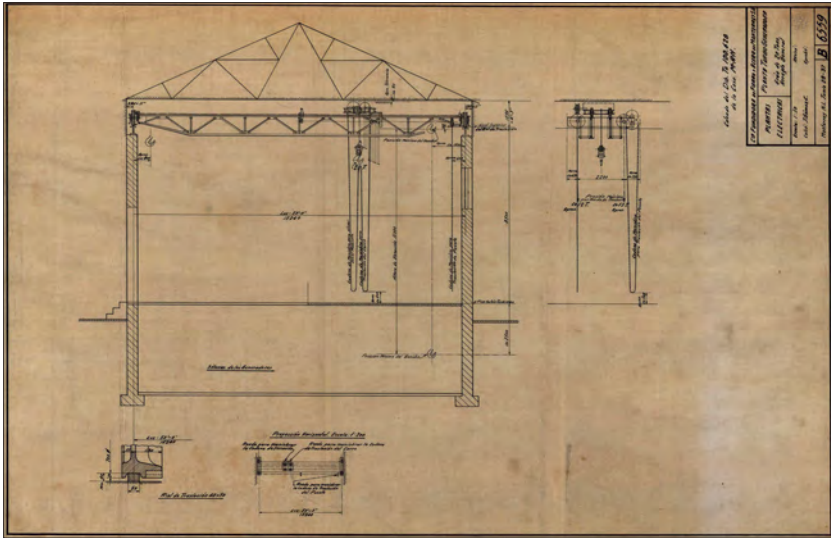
AHF Plano B-6559 Planta Turbogeneradora. Grúa de 20 Tons. Arreglo General. Monterrey, N.L., junio 28-37. Planoteca.
